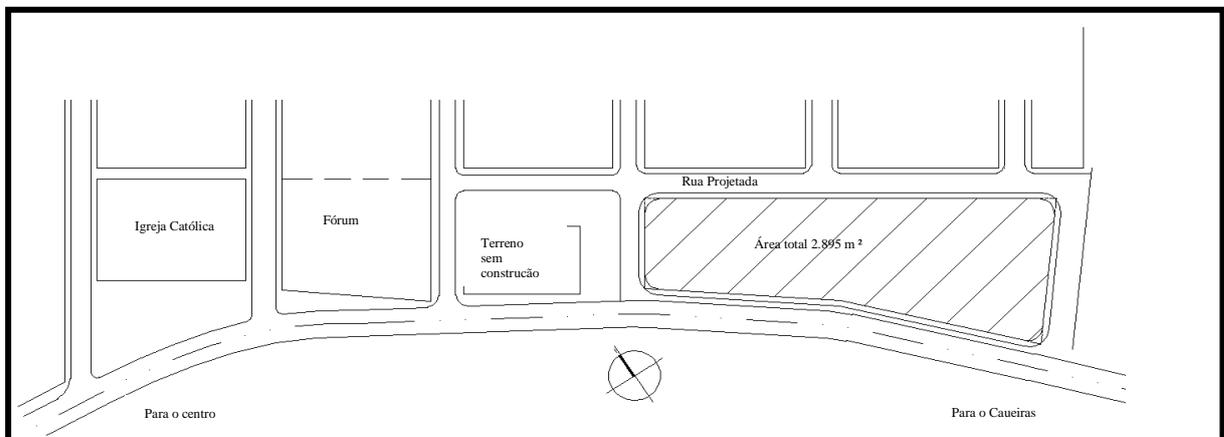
Planta de Situação da Academia da Cidade de Aliança.
